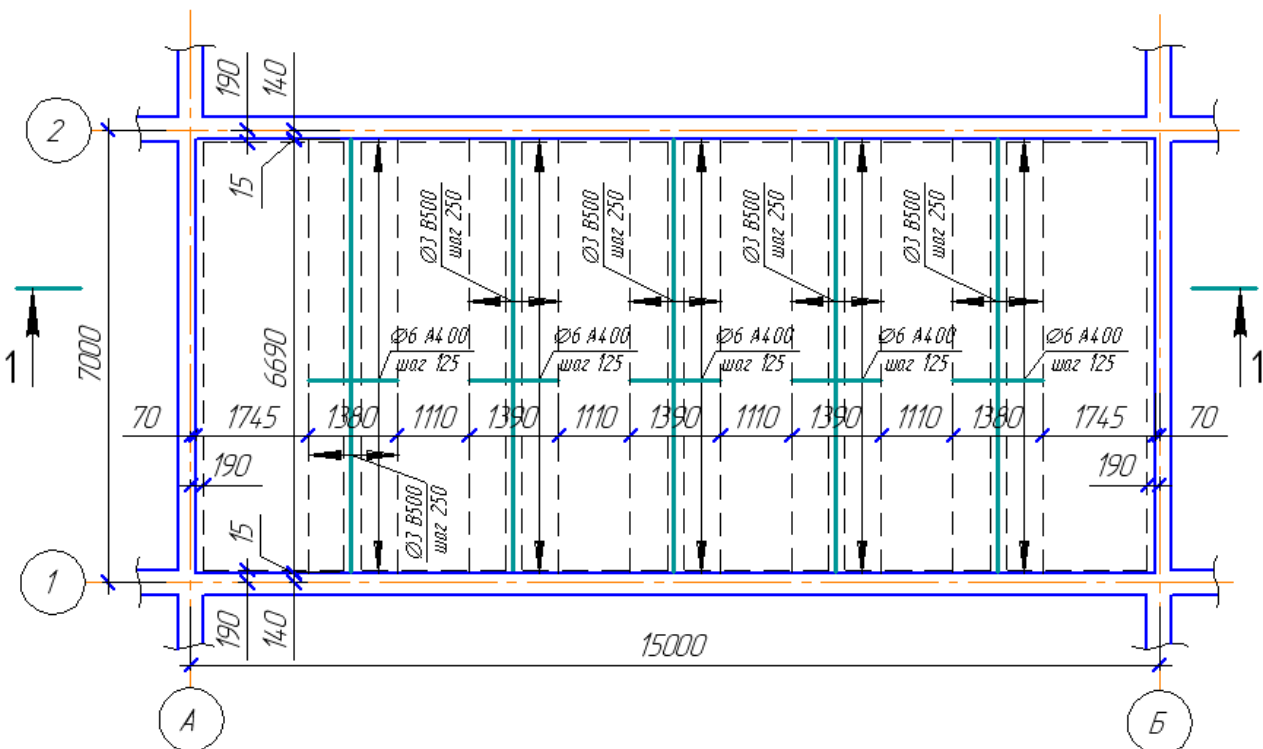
Схема раскладки верхней арматуры плиты перекрытия
